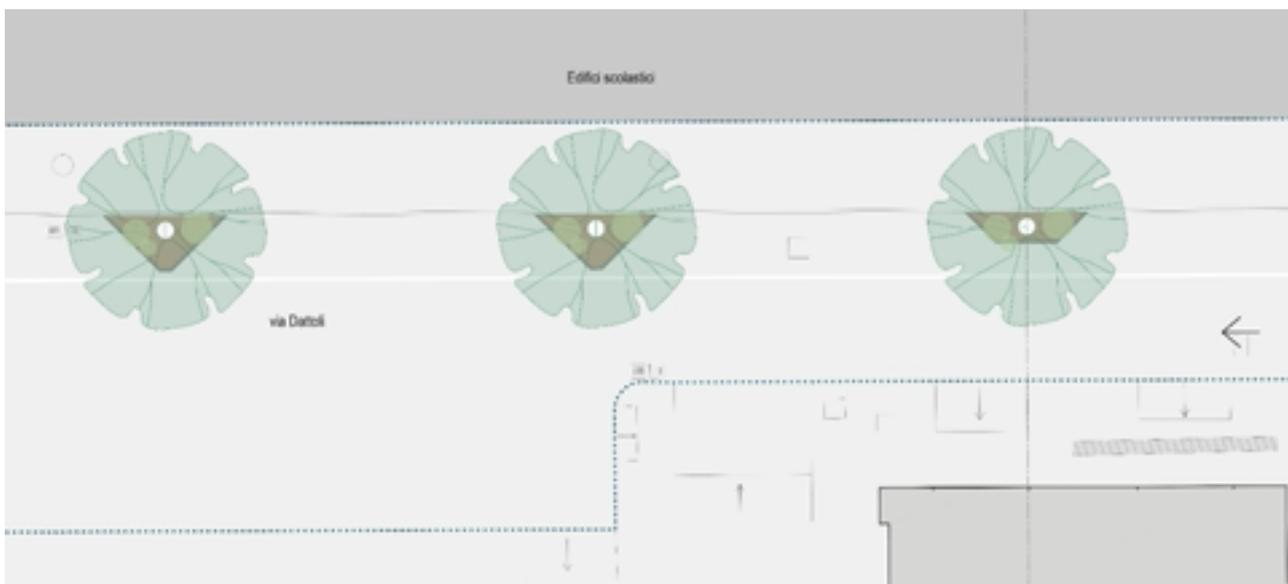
stralcio planimetrico di via Dattoli con individuazione delle due differenti tipologie di alvaretto
